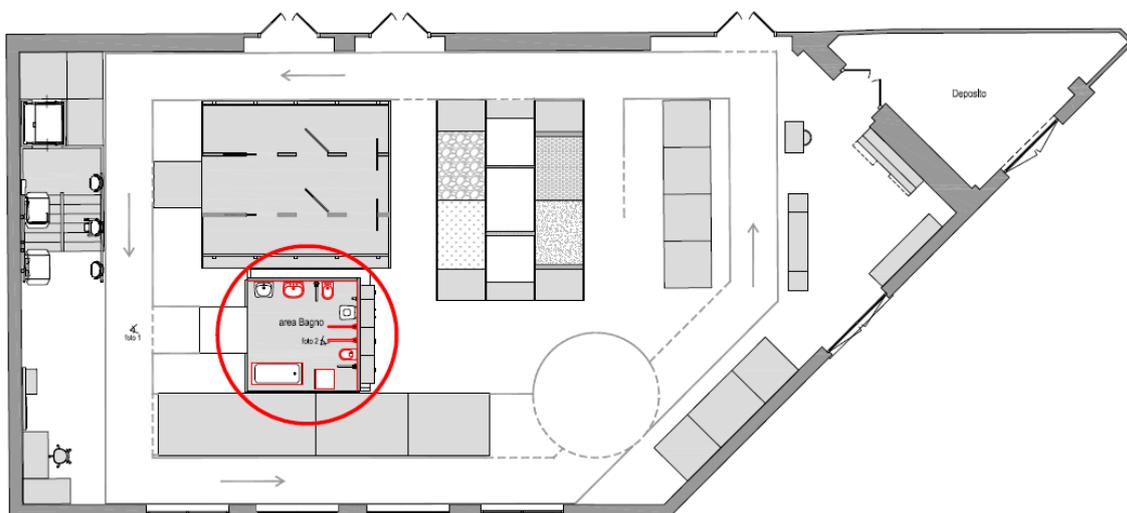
Planimetria Palestra di AUSILIA - Area Bagno
